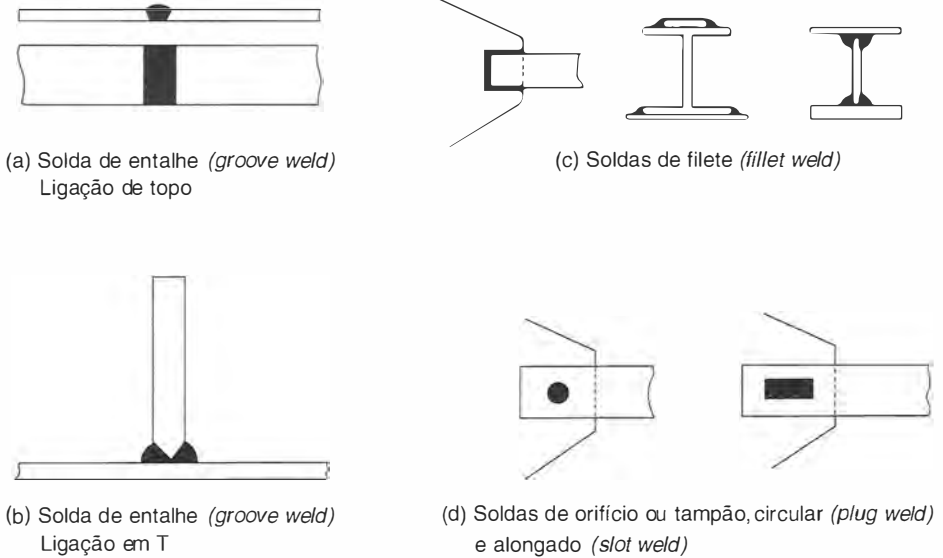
Tipos de ligações soldadas, segundo a posição da solda em relação ao material-base.
